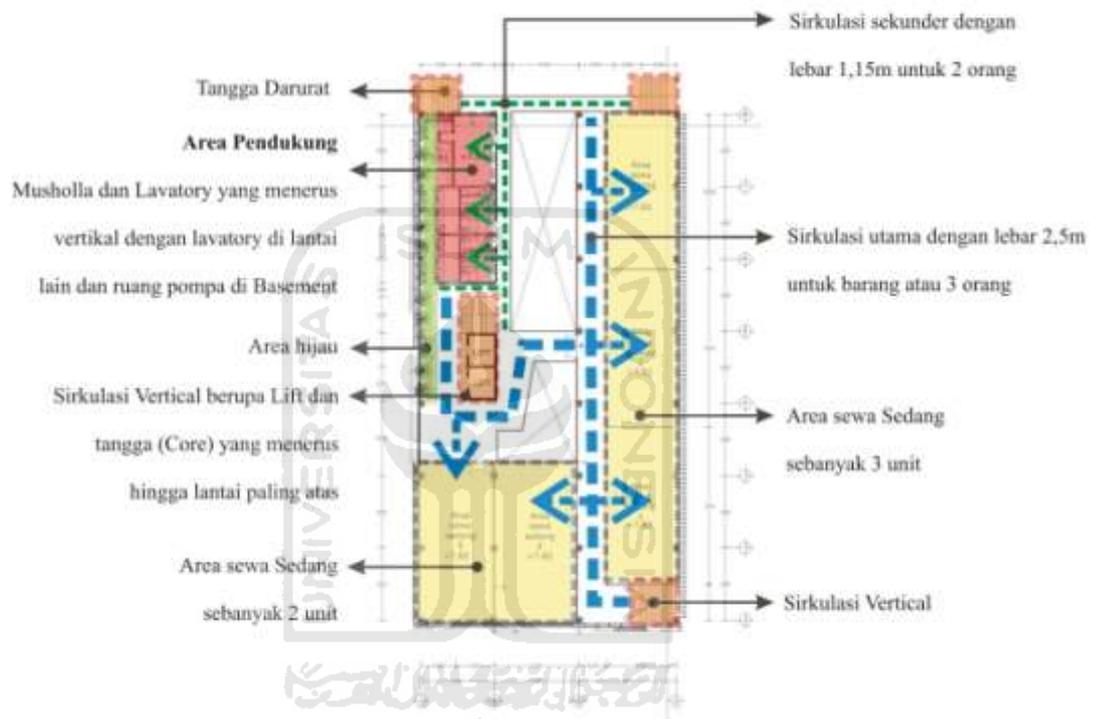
Konsep Zonase Ruang Lantai 1
